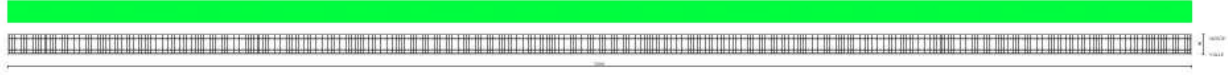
Piastra fondazione dir. Y (Inviluppo)
